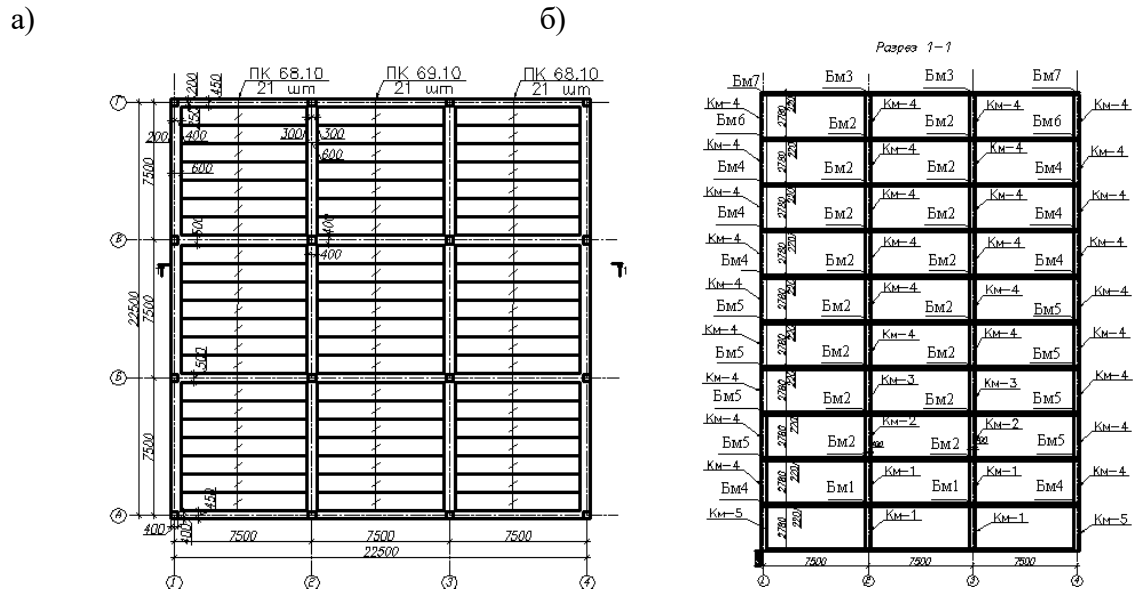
а) Схема розташування елементів перекриття; б) Поперечний розріз будівлі:
